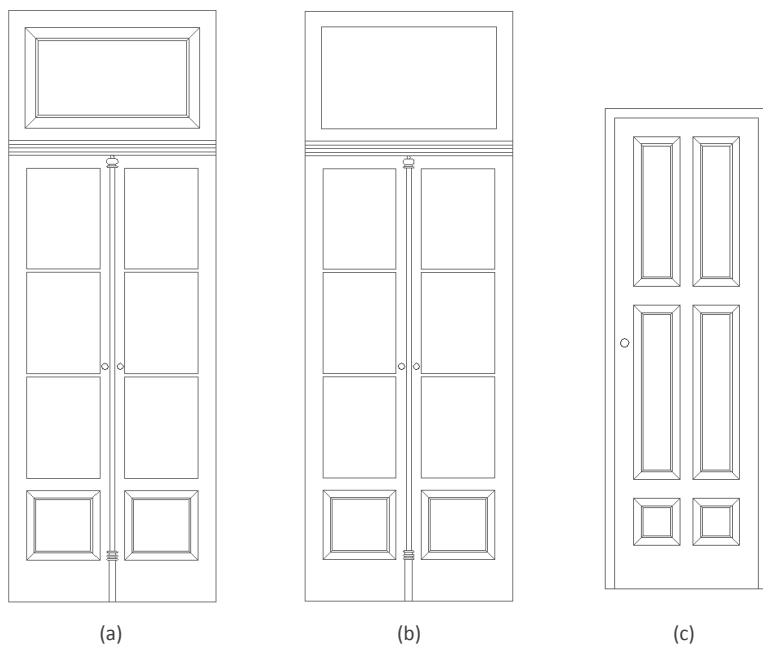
Alçado tipo de portas interiores encimadas por bandeira fechada (a), por bandeira com caixilho em vidro (b) e sem bandeira (c).
